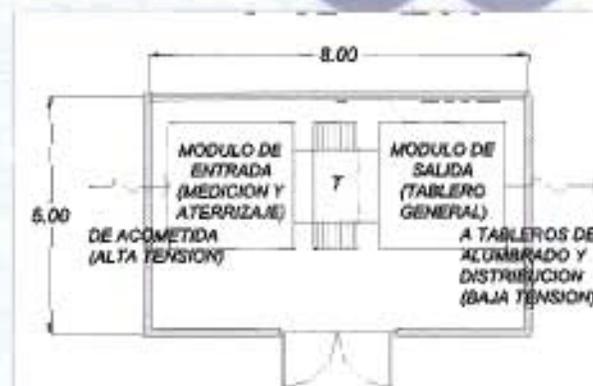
Planta Esquemática del Cuarto de Máquinas Eléctrico
